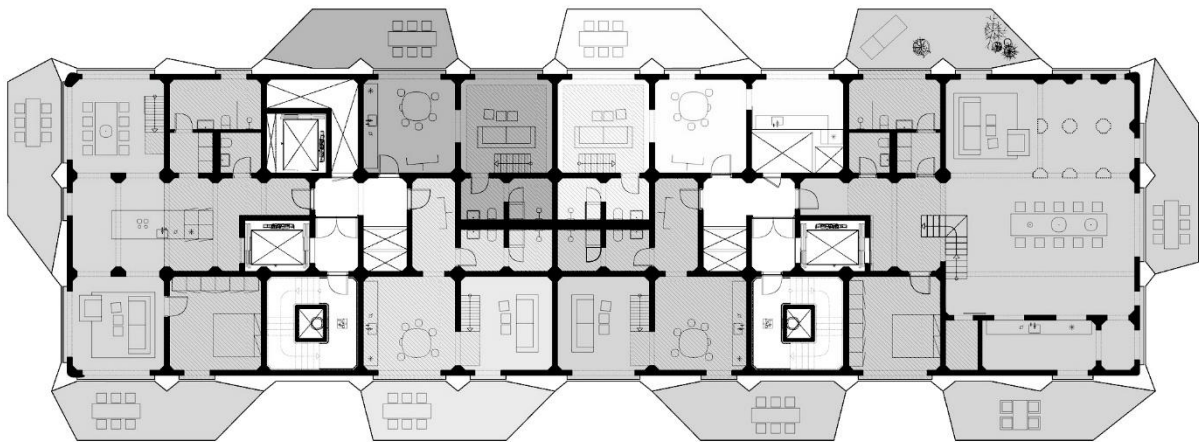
Grundriss vom einem Regelgeschoss
